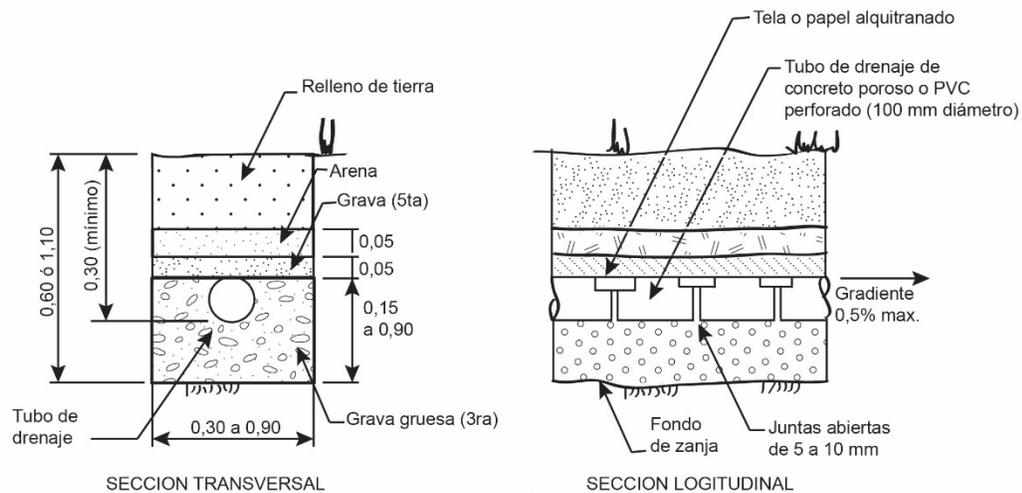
Secciones transversal y longitudinal de una zanja de infiltración.
